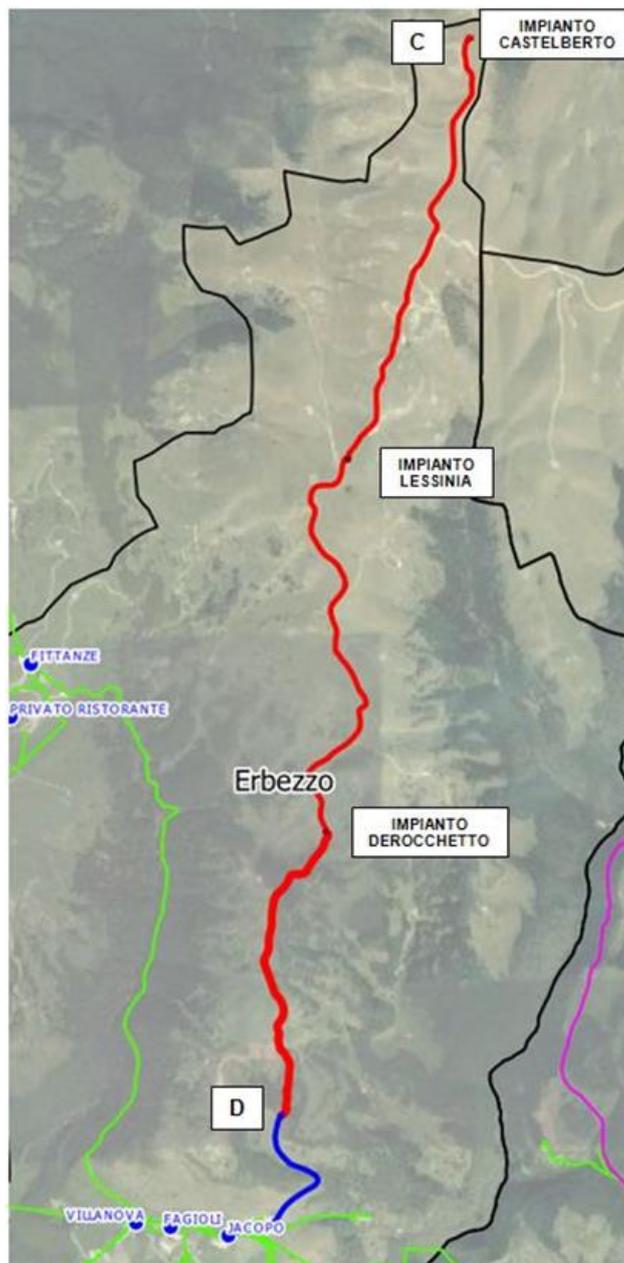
Planimetria generale del tracciato CD. In rosso il tracciato di progetto, in blu il tracciato oggetto di altra progettazione (serb. Jacopo – nodo D), in verde la rete esistente
